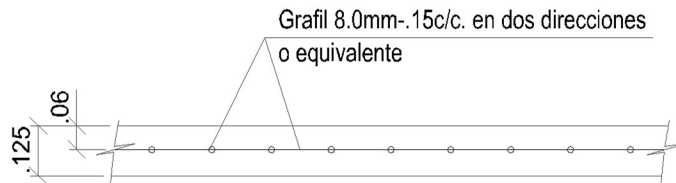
Detalle acero de refuerzo placa (archivo propio)
